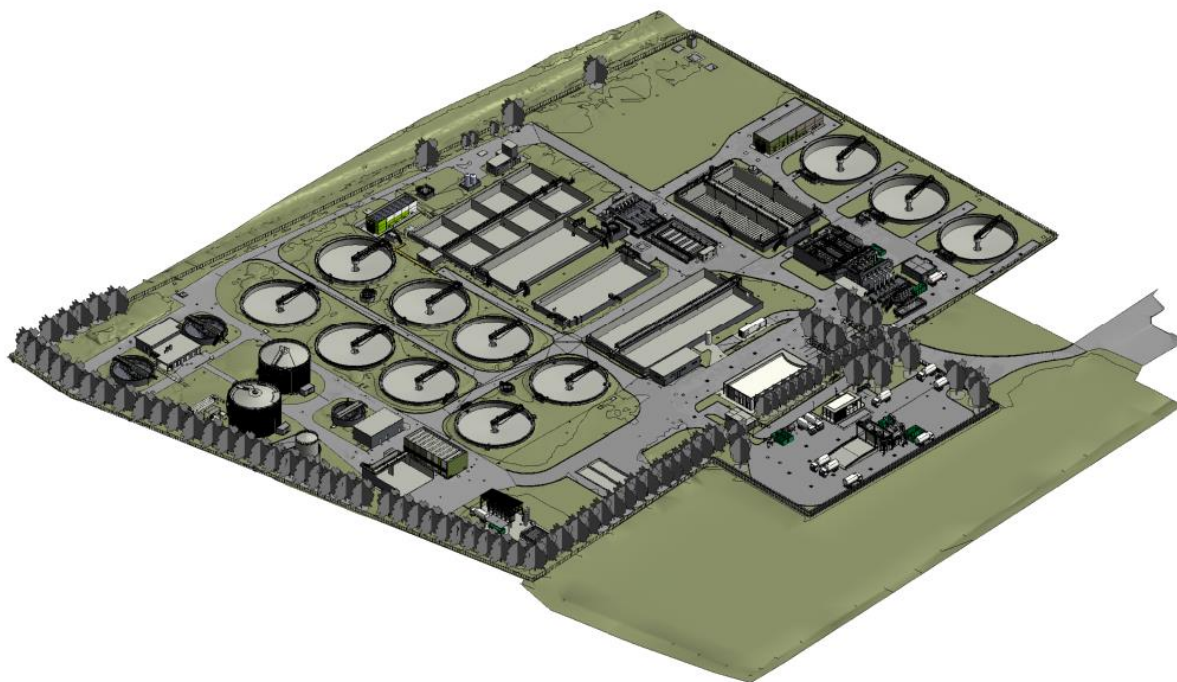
Layout stato di progetto impianto di depurazione di Ravenna
